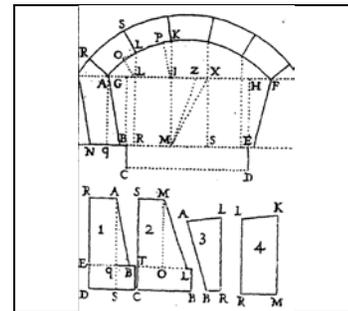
Trazo para arco escarzano, con capialzado recto.
